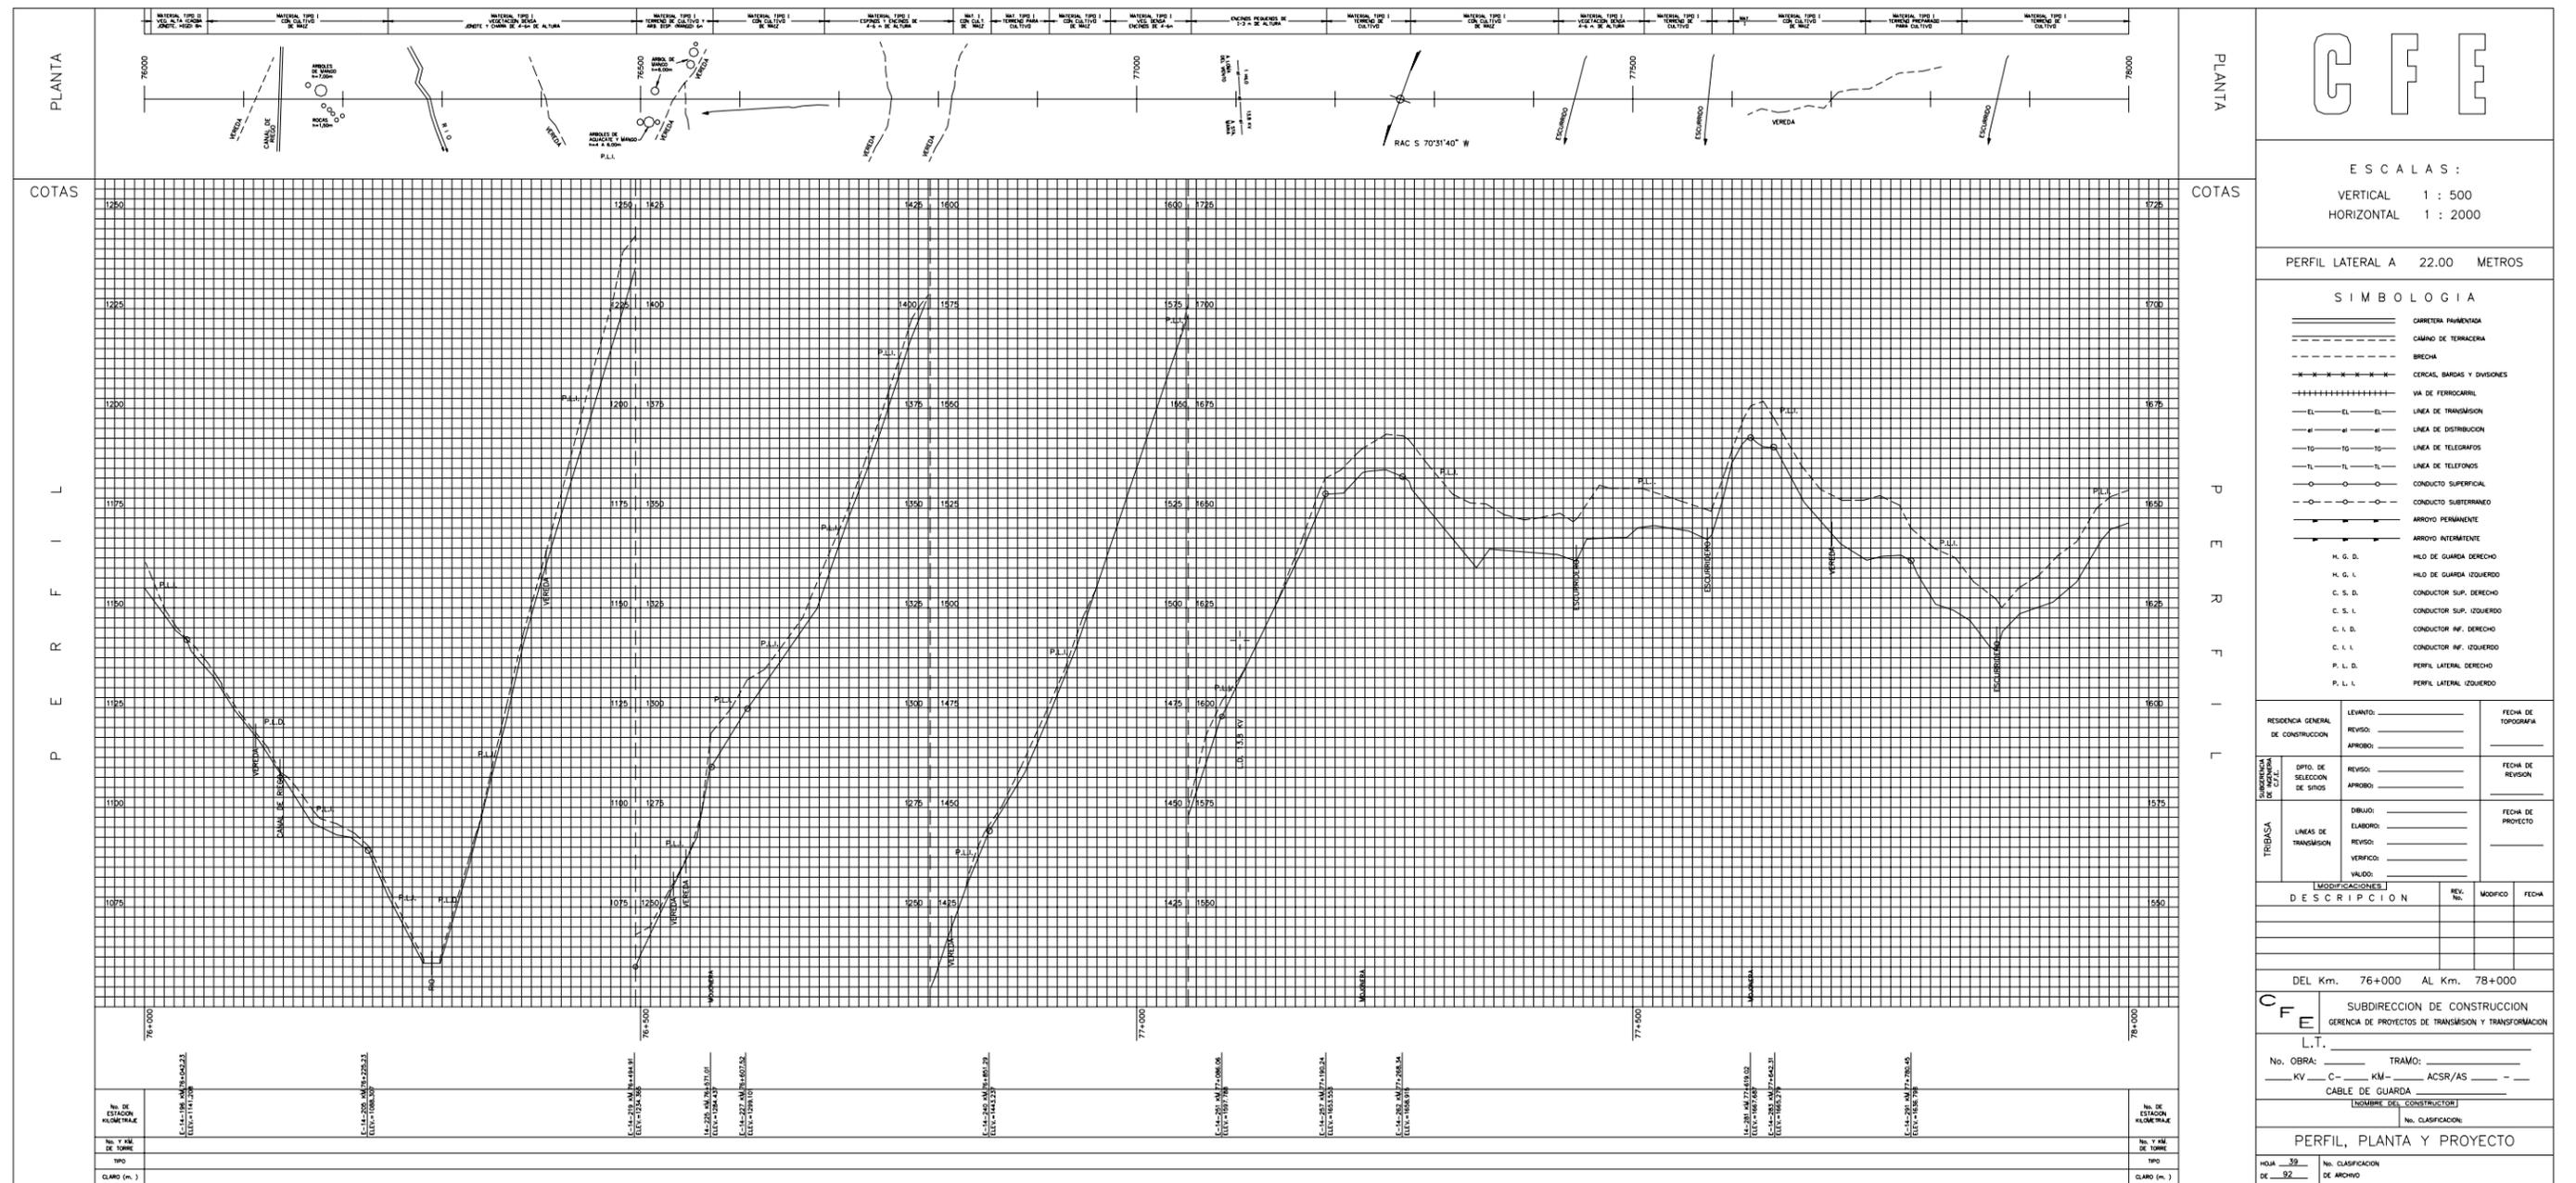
Plano Perfil y Planta Terreno Montañoso
